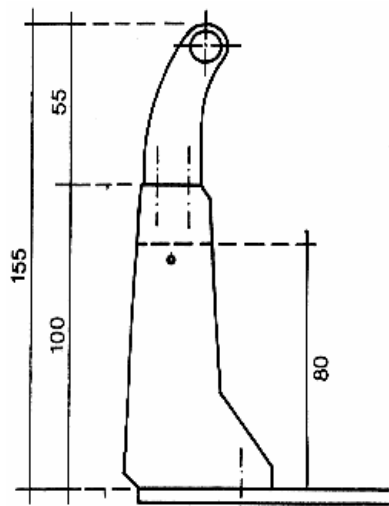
Barriera da viadotto "PANORAMICA" con mancorrente.
